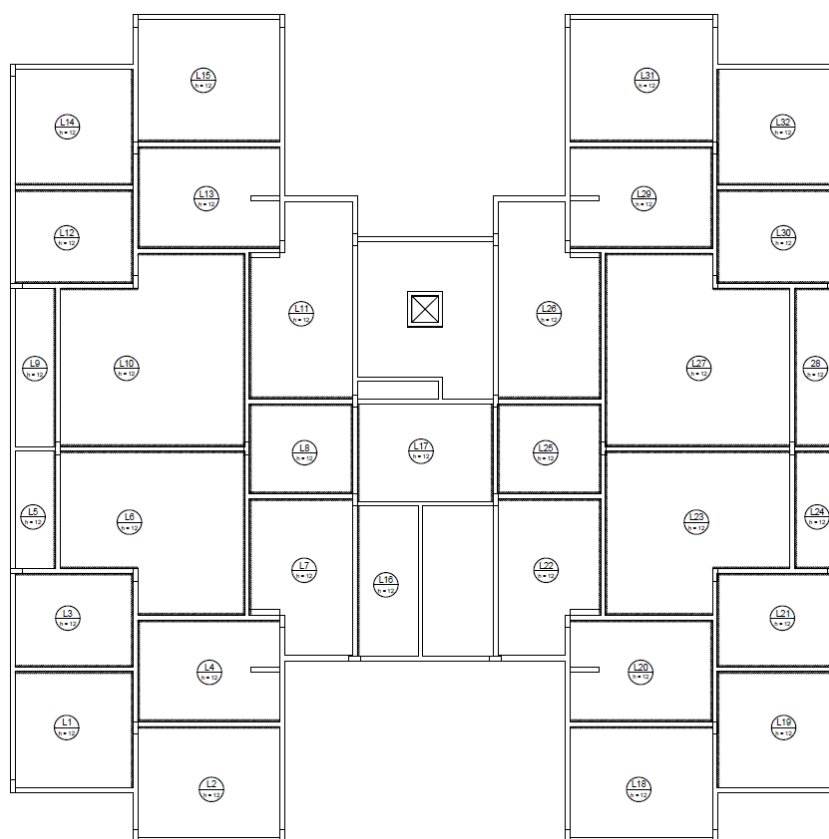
VINCULAÇÕES DAS LAJES DO PAVIMENTO TIPO
